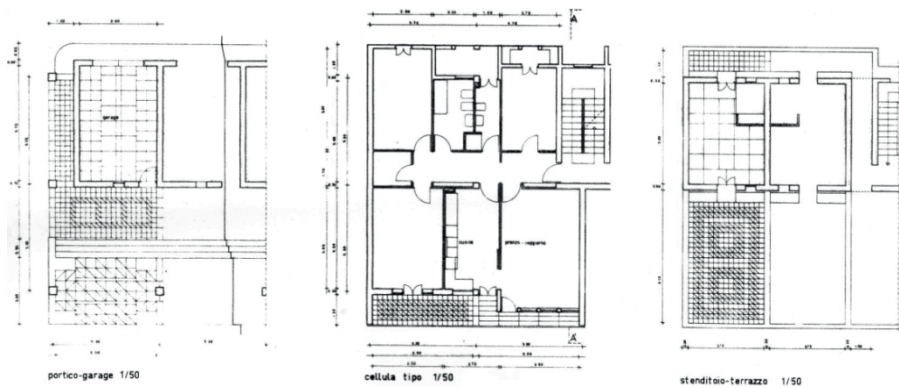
/14/15 – Piante piano terra, piano tipo e piano terrazzi-stenditioi dell'unità residenziale.
